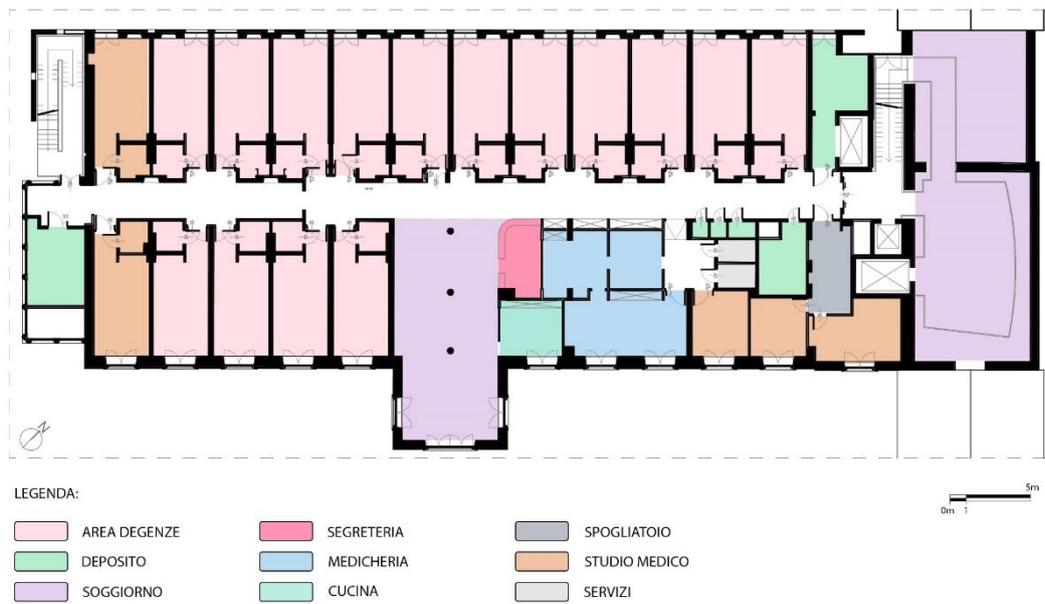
Planimetria padiglione 1 complesso Ospedaliero Mauriziano, piano B.
